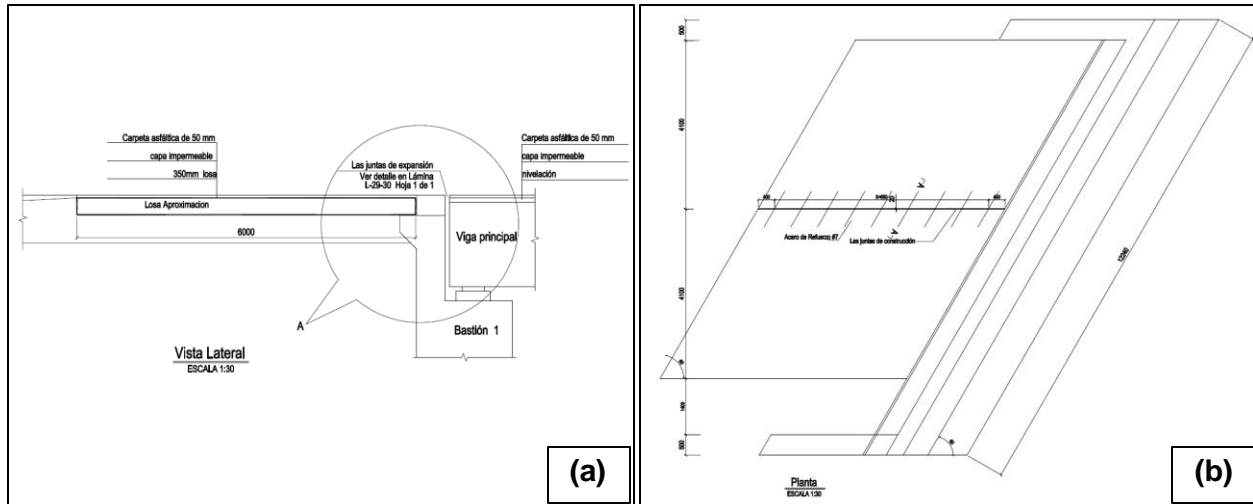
Detalle de la losa de aproximación del puente nuevo sobre el río Cuba (puente con sesgo de 30°). (a) Vista en elevación. (b) Vista en planta.
